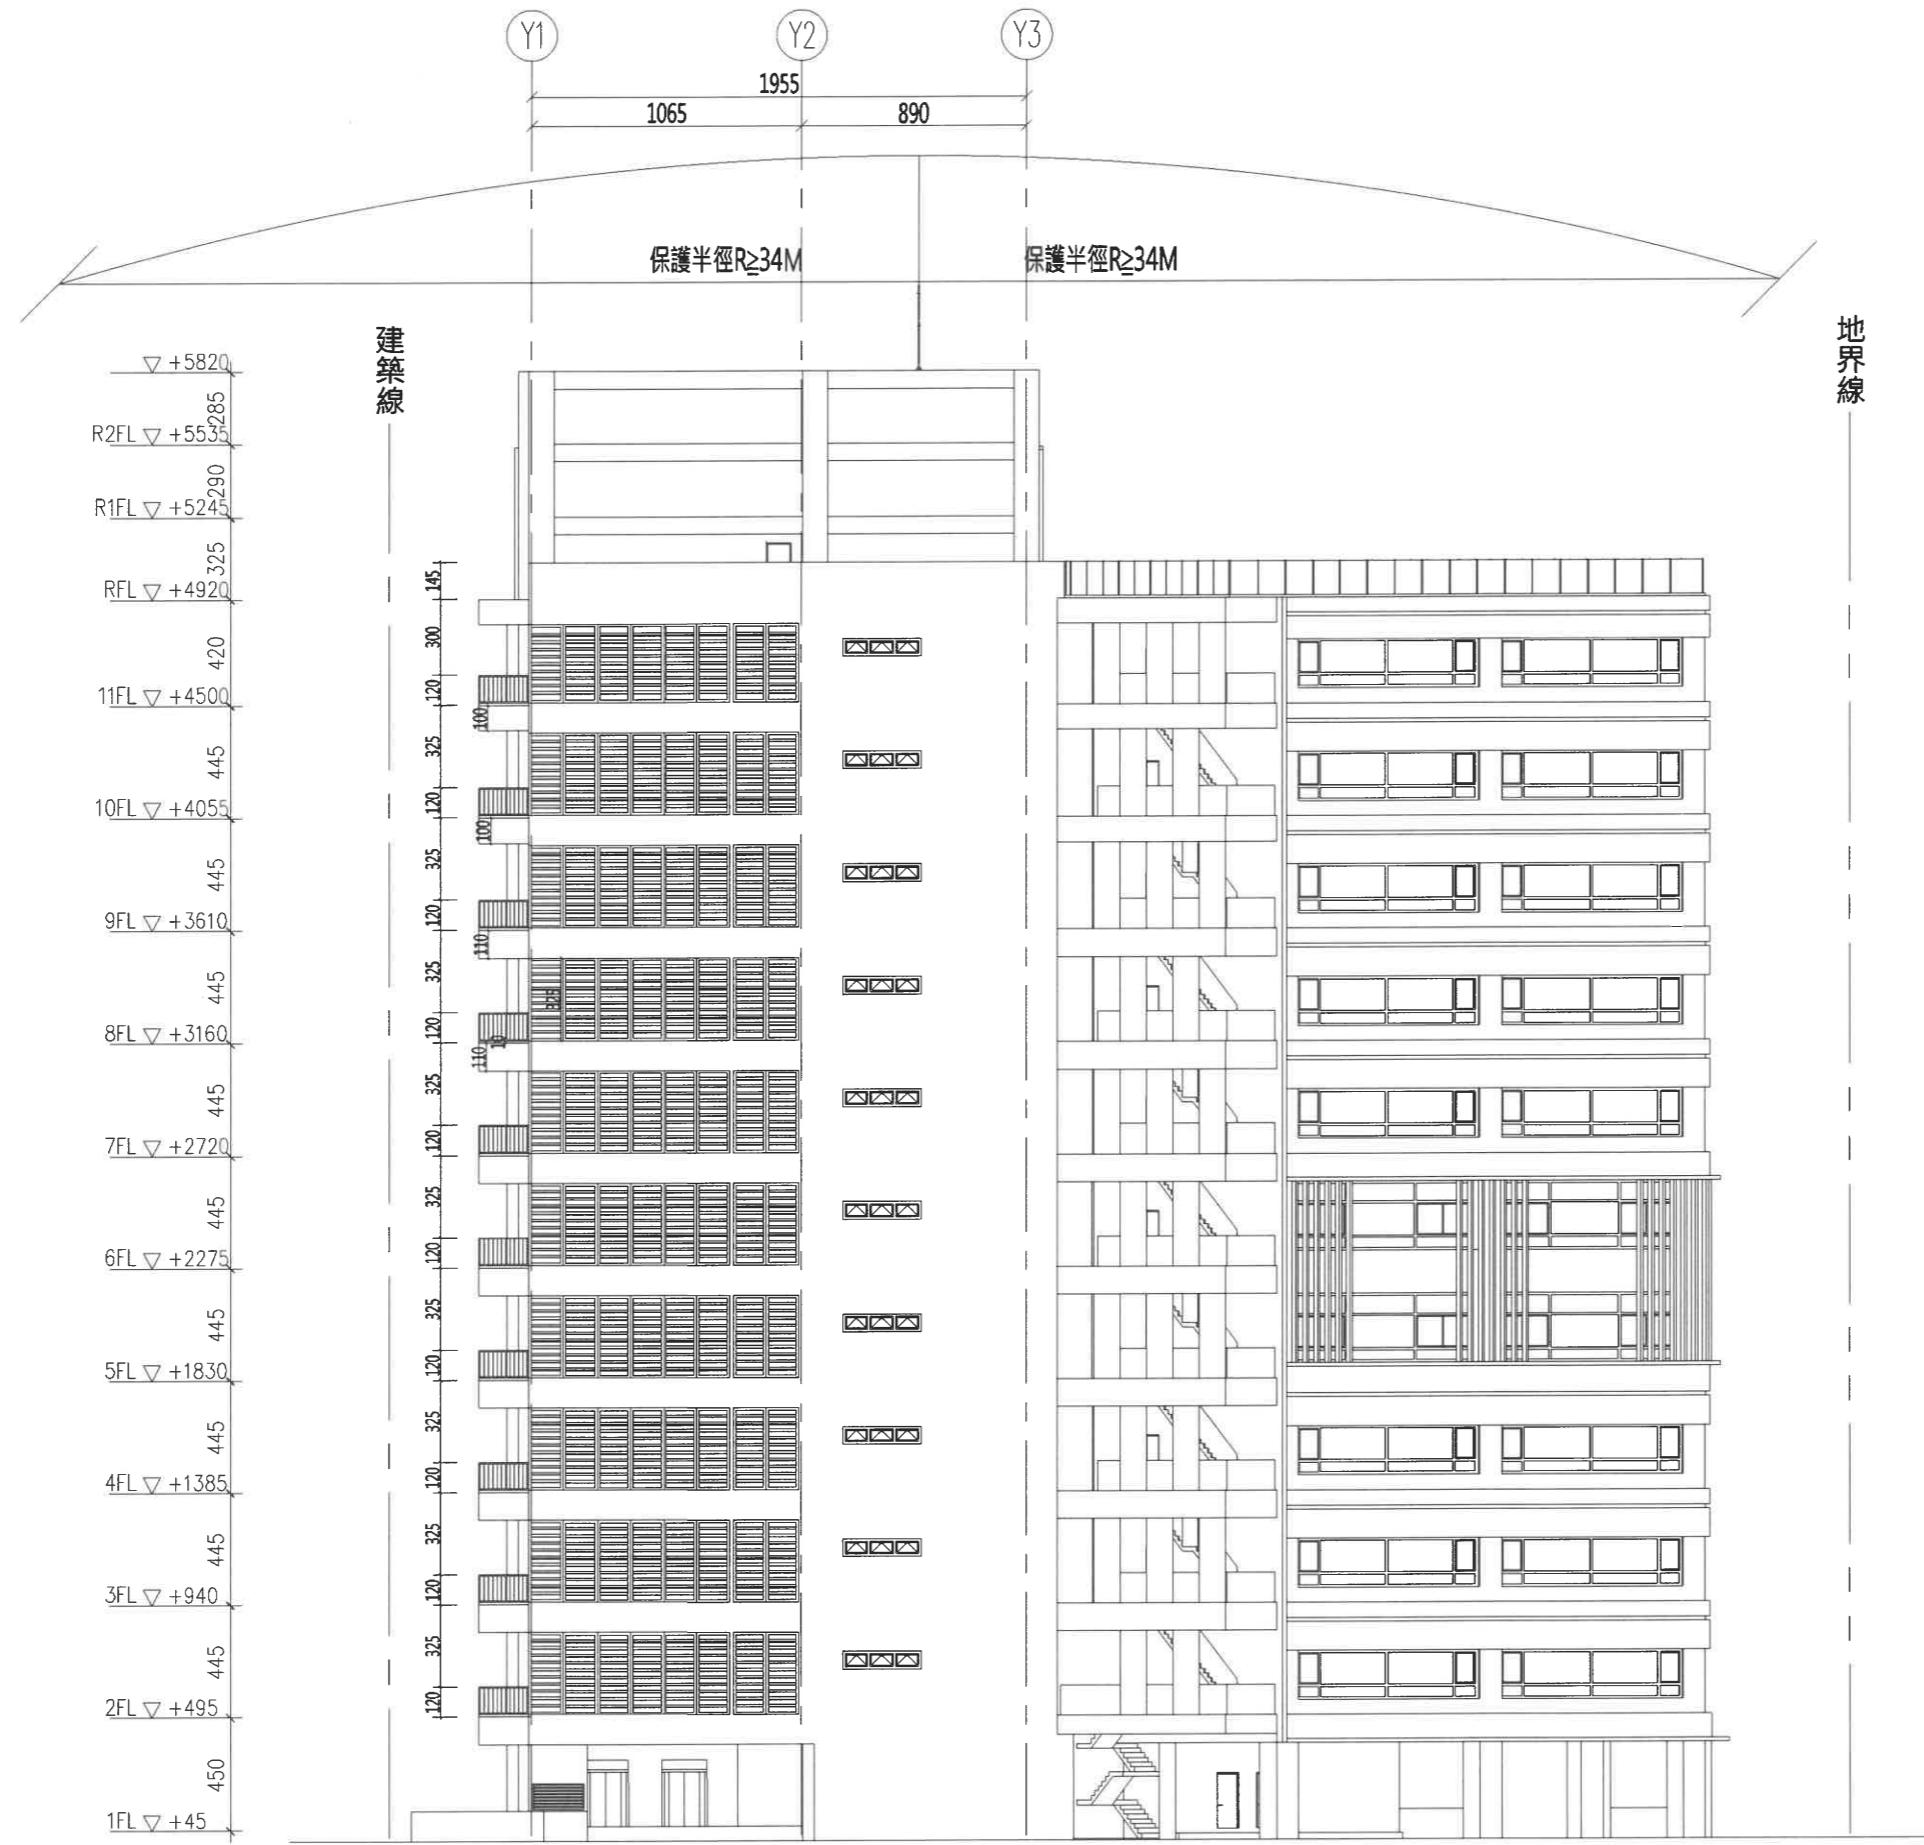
西南向立面圖(維持原核定)(S : 1/300)
